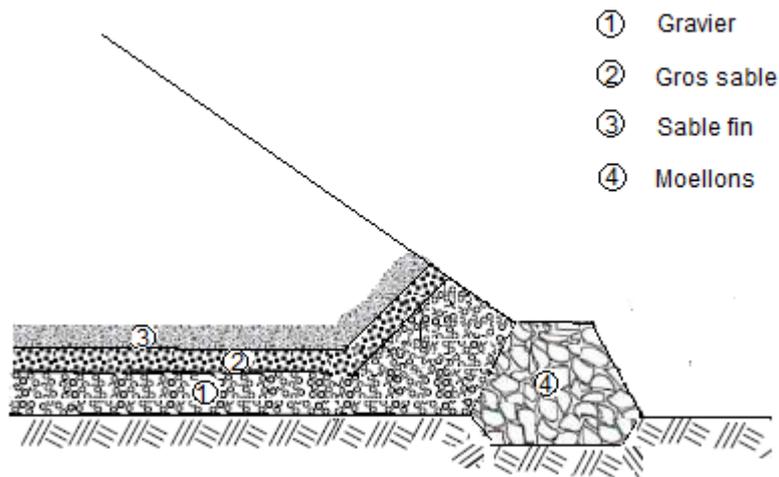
Disposition du drain et du filtre (fondation imperméable)
